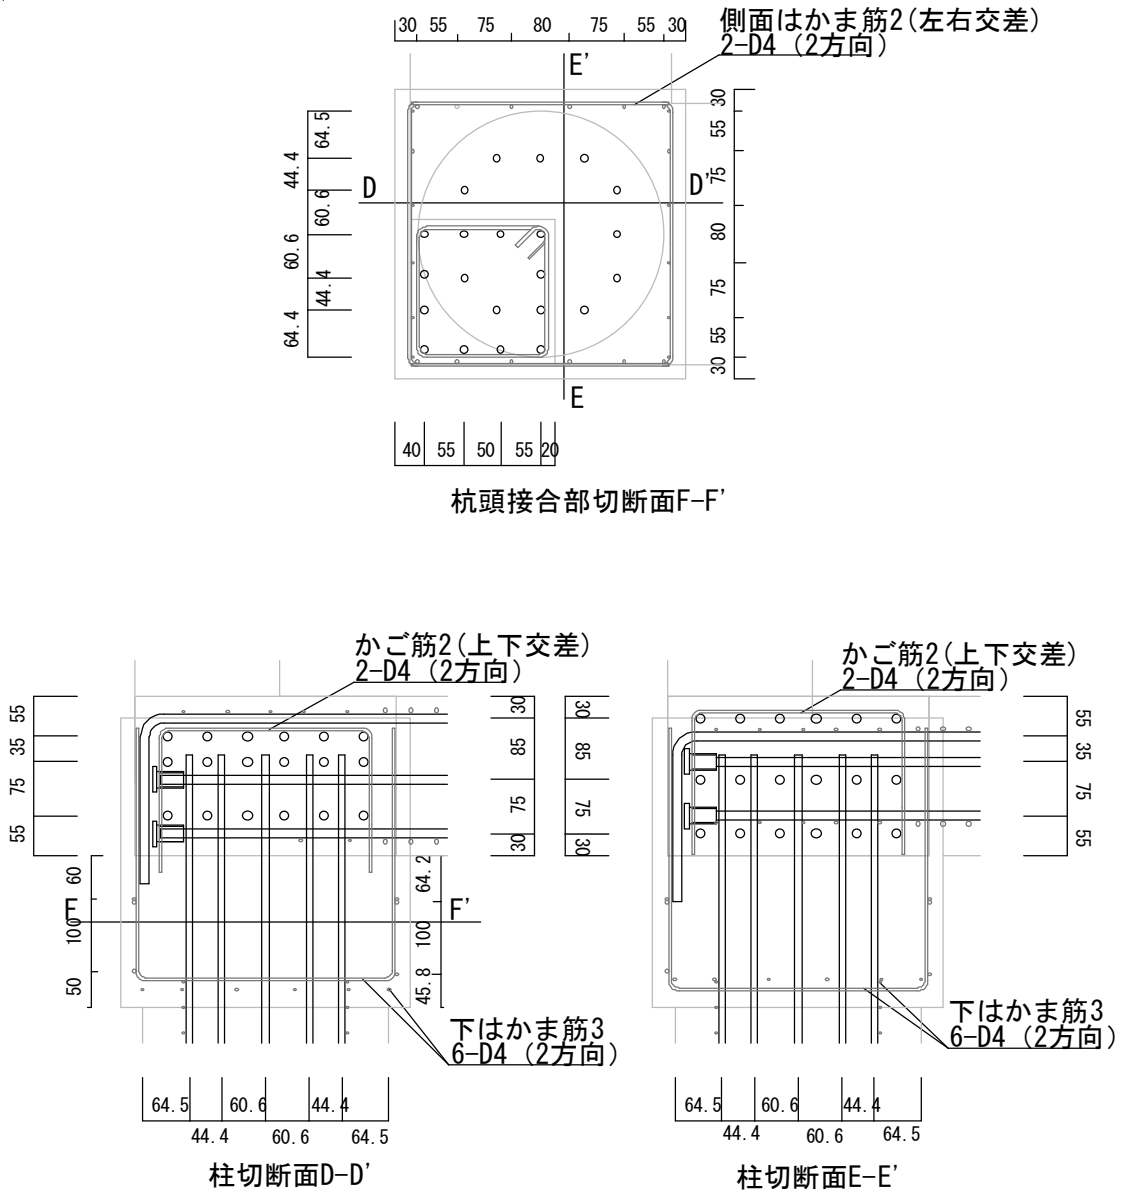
E88 試験体配筋状況 (杭頭接合部切断面)
